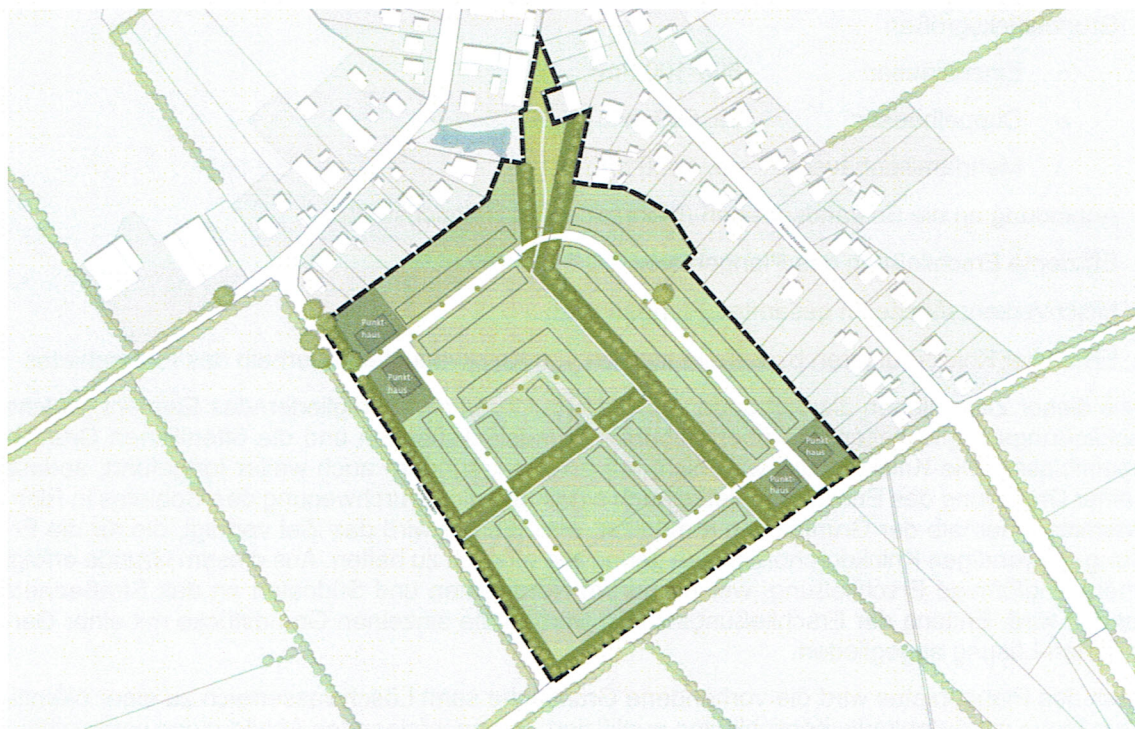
Städtebauliches Konzept - Bebauungsstruktur (Evers & Küssner / Stadtplaner)
